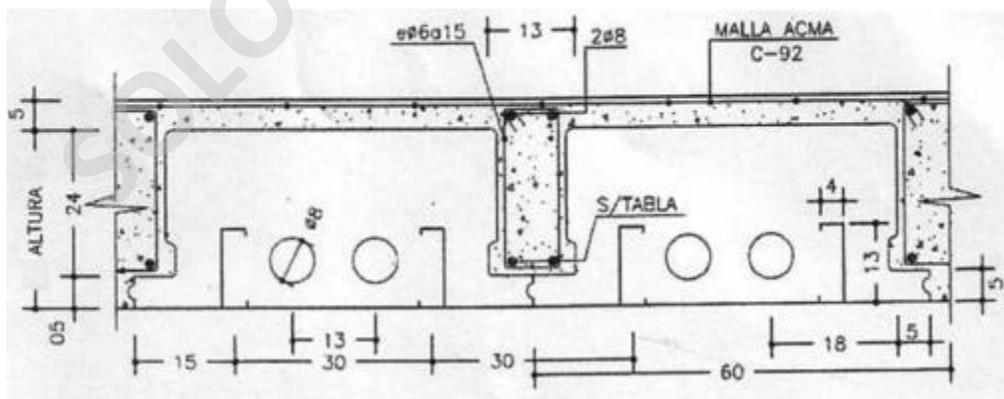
Corte trasversal losa liviana con panel de entrepiso aislante
